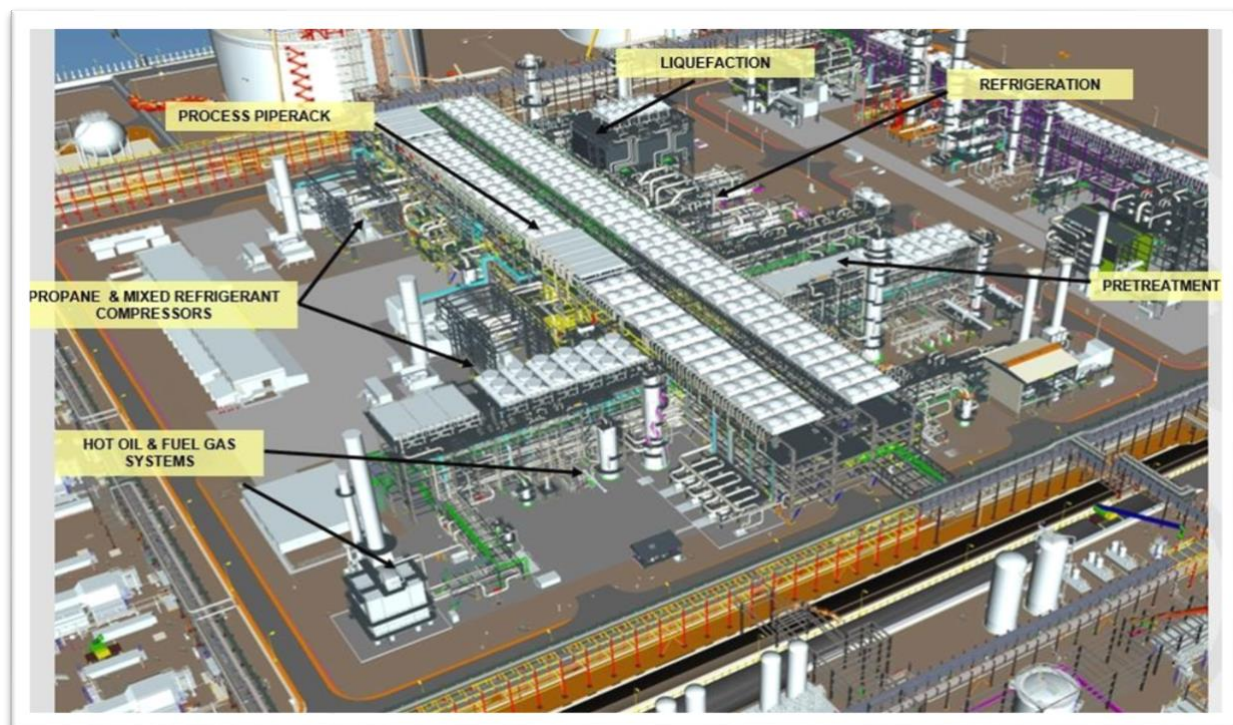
Vue 3D d'Ensemble du complexe GL3/Z
